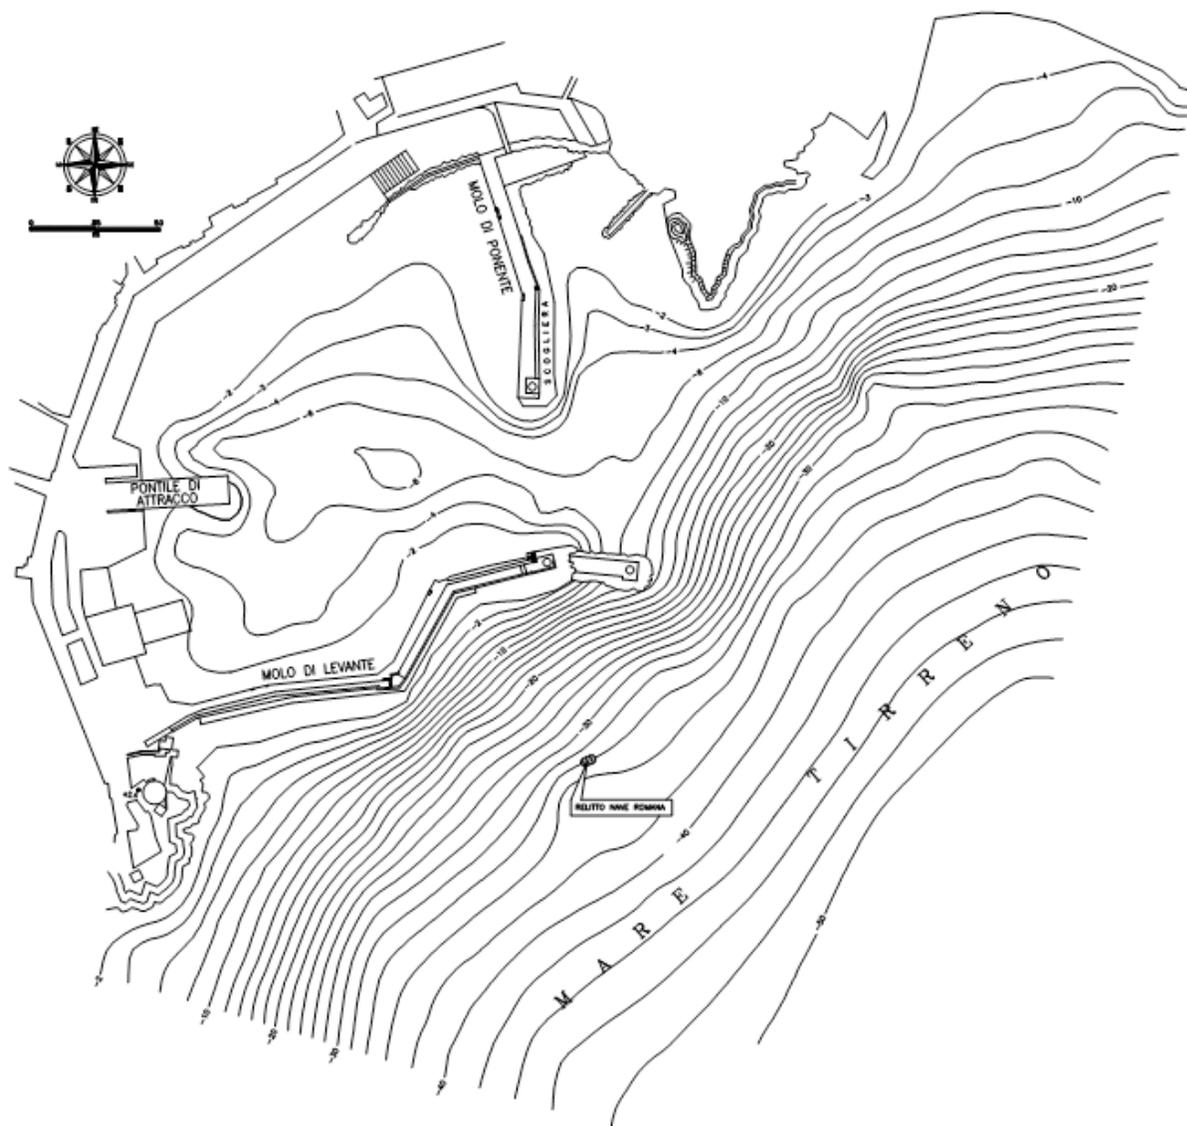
Planimetria del porto con indicazione delle opere previste dal P.R.P. vigente (1978)
